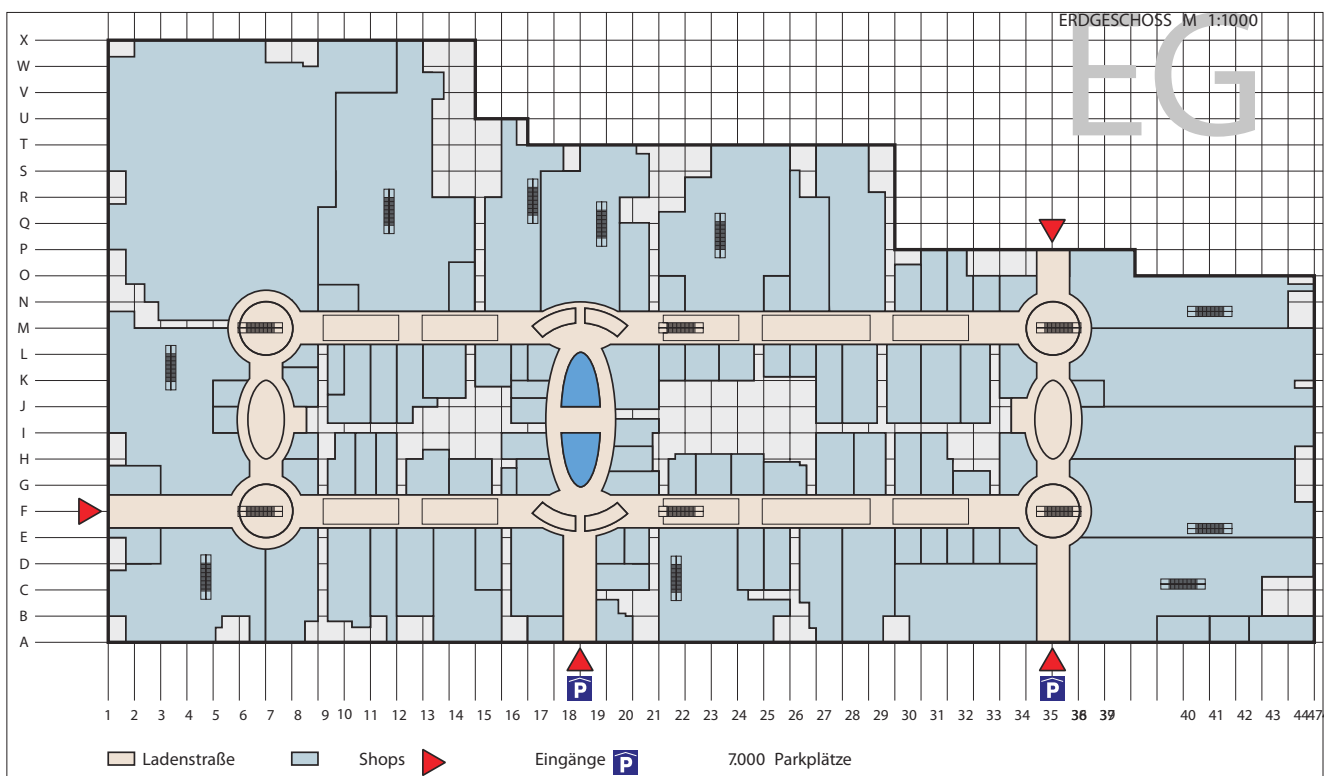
Schema Grundriss EG (Quelle: ECE)
